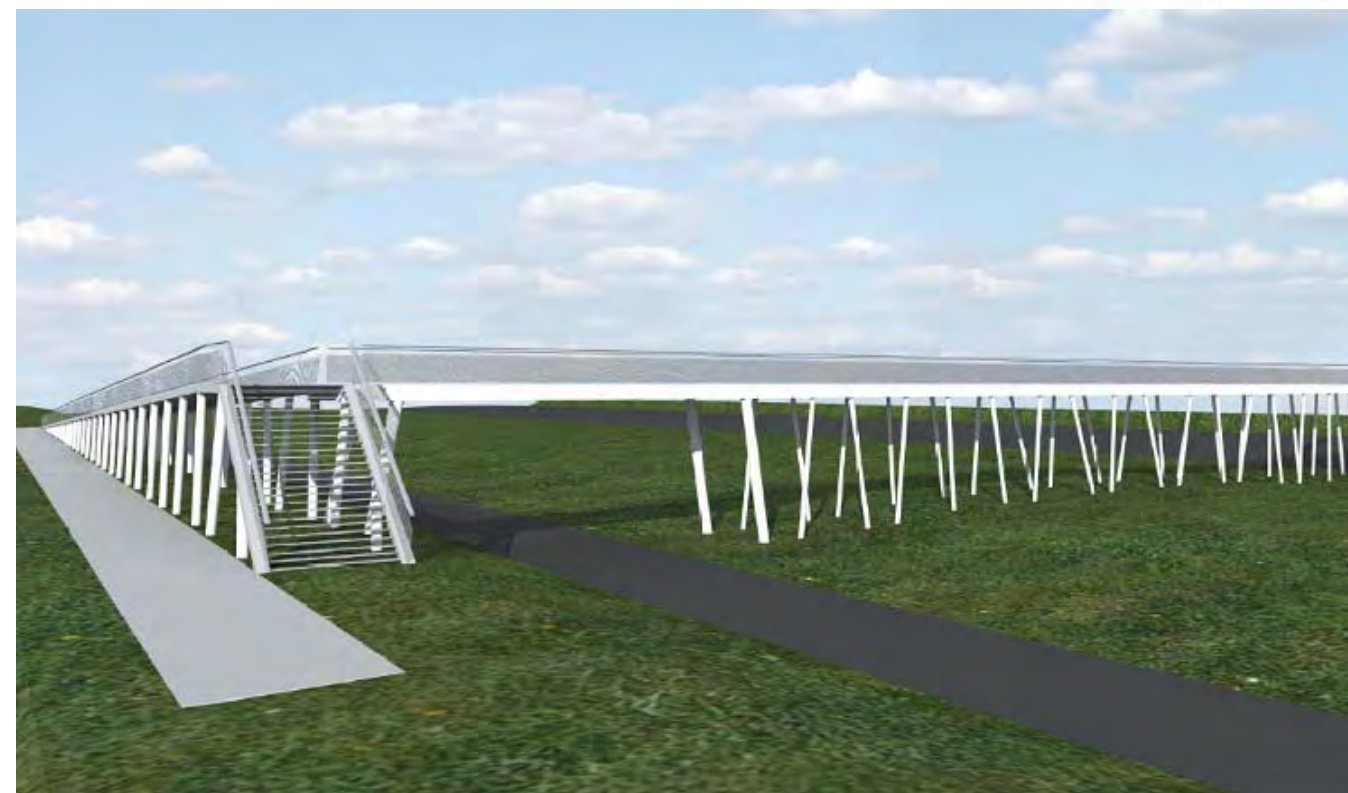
Passerelle au dessus de la bretelle A480N vers RN87 : Rampe d'accès longeant le Drac (vue depuis Seyssins en direction de l'Est)
